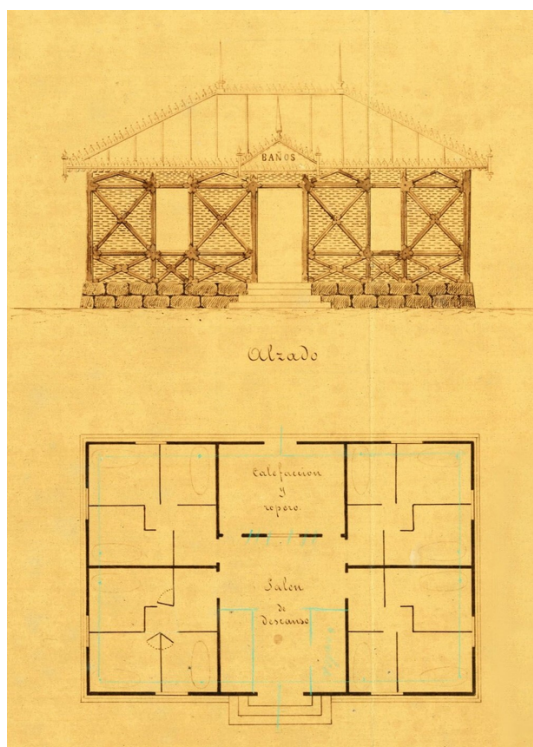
Vila y Algorri, E. (1887): *Alzado y planta de la casa de baños.* APC, A Coruña (0024-0103PLAN003)
